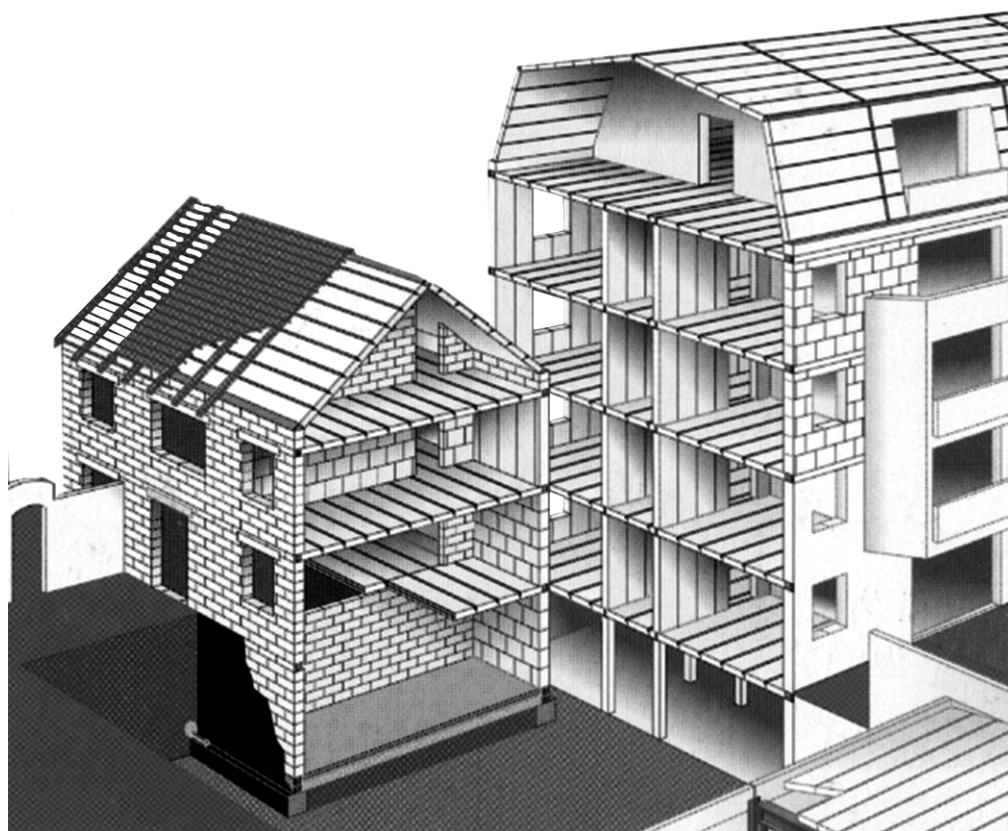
Схемы домов с мансардными и газобетонными перекрытиями (настилами)
